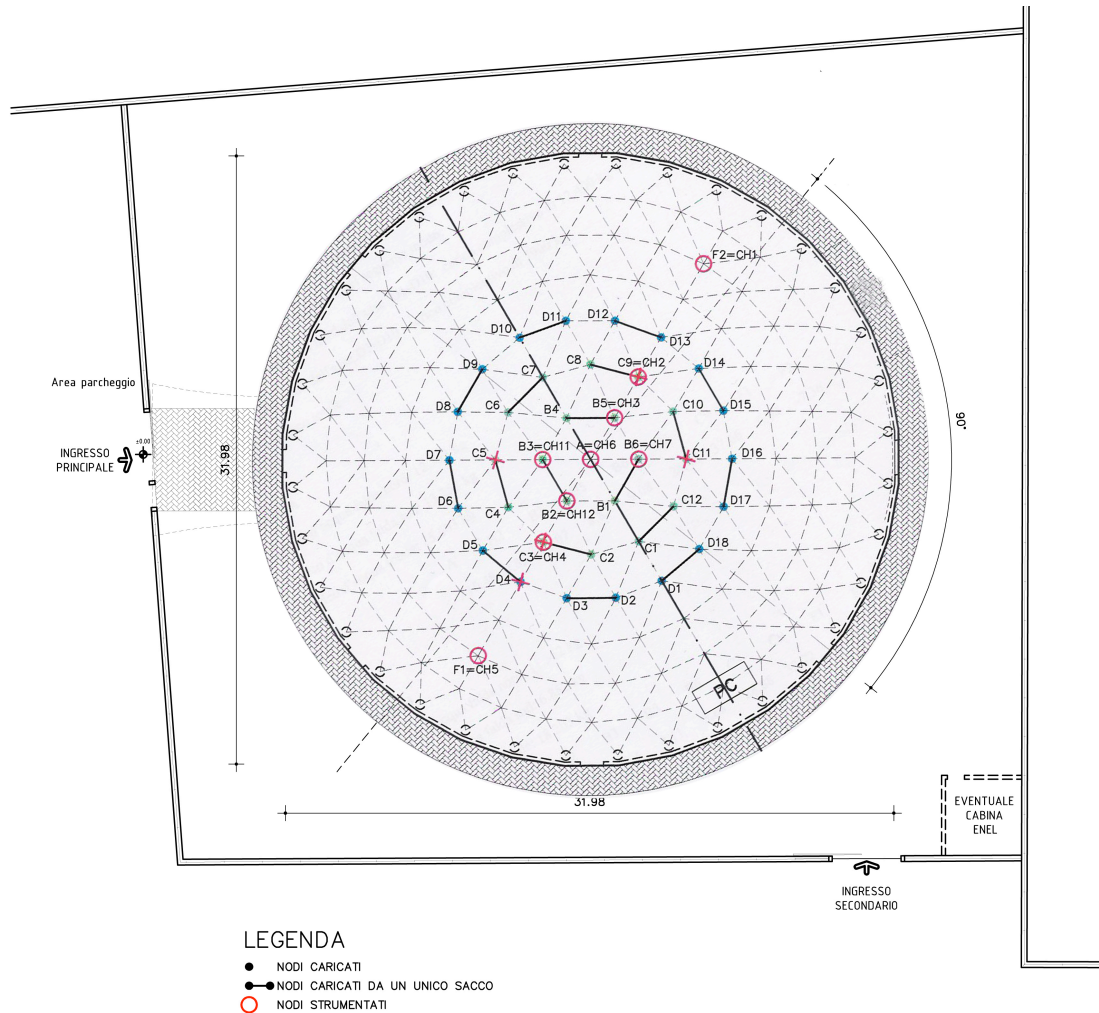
Pianta dell'edificio e schema di carico della prima prova
